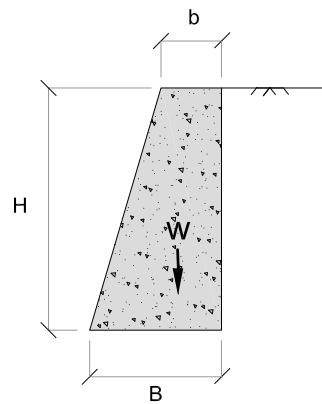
Muro de gravidade com perfil trapezoidal (adaptado de Domingues (1997)).
